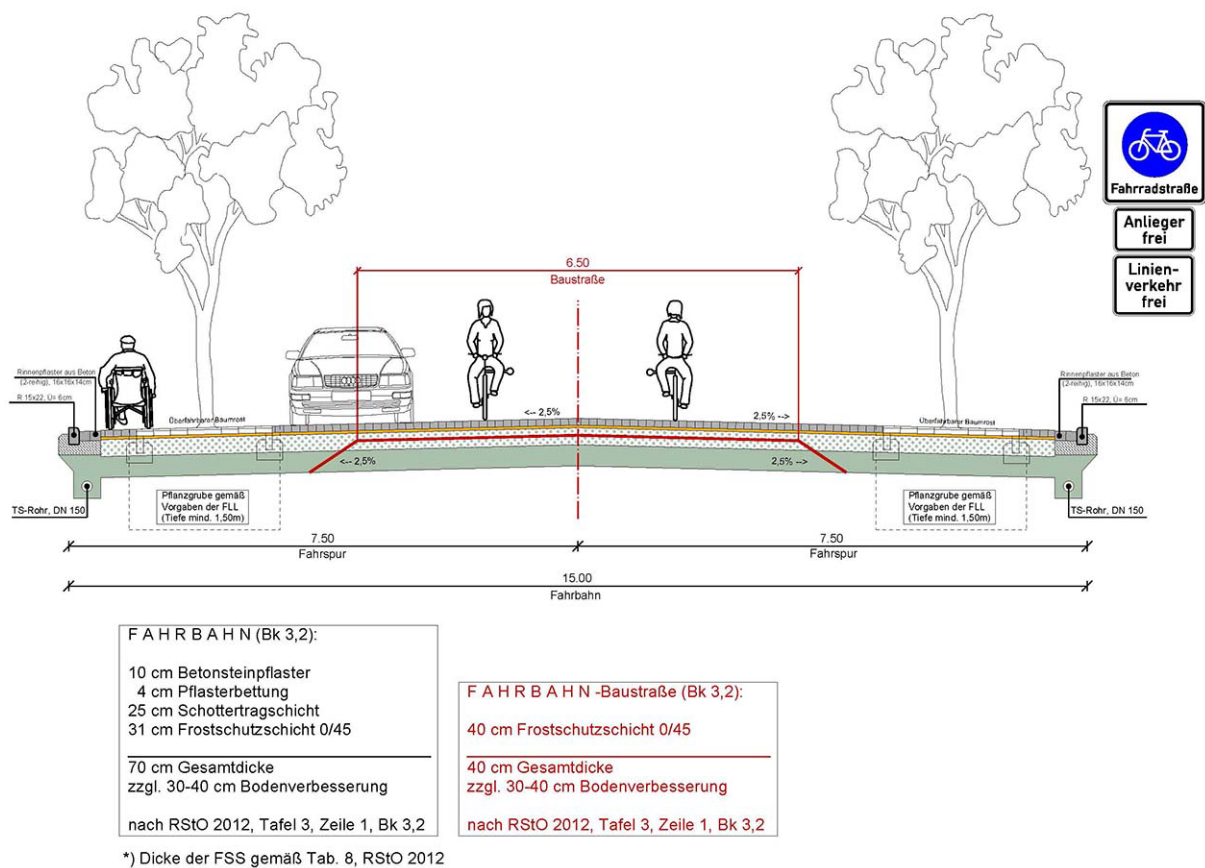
Straßenquerschnitt im Bereich der Querverbindung (Quelle: IMB Plan, Hanau)
